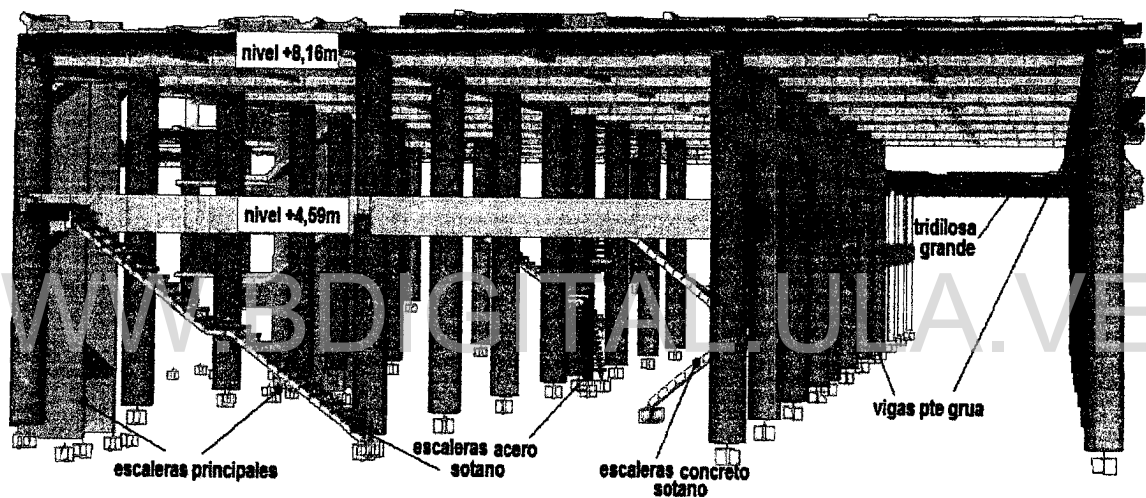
, Detalle modelado de escalera en sótano y viga izquierda de puente grúa en eje C.
